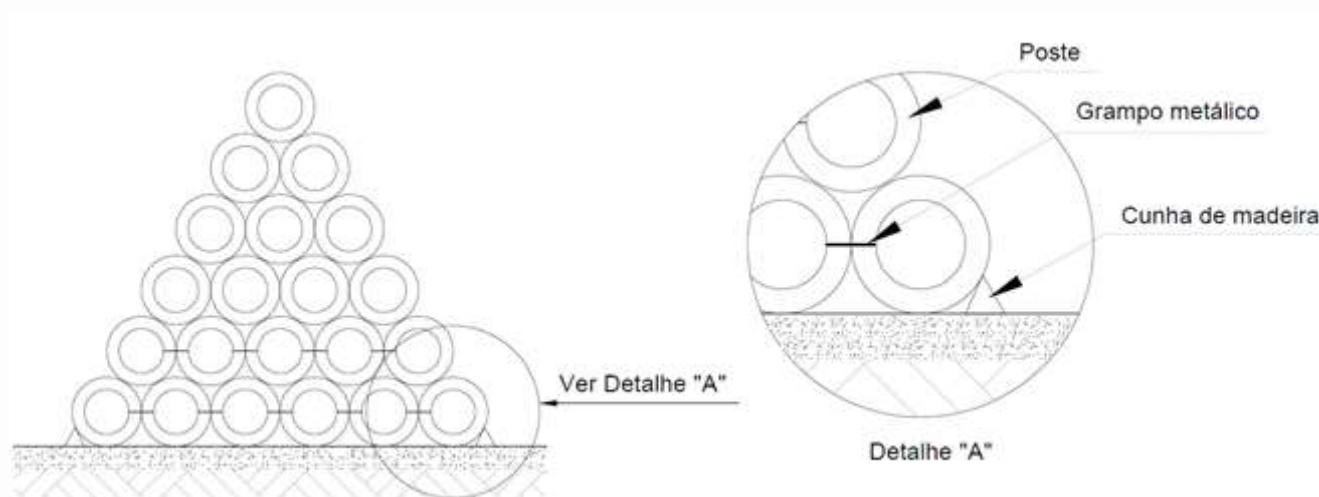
Exemplo do uso de cunhas de madeira e de pilha piramidal
